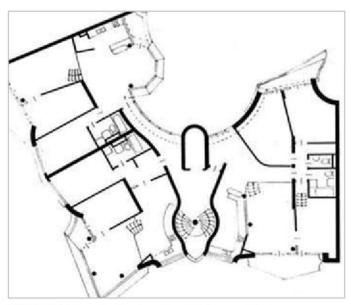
| Unregelmäßige Grundrisse 1 (Wohnungen, Büros)
